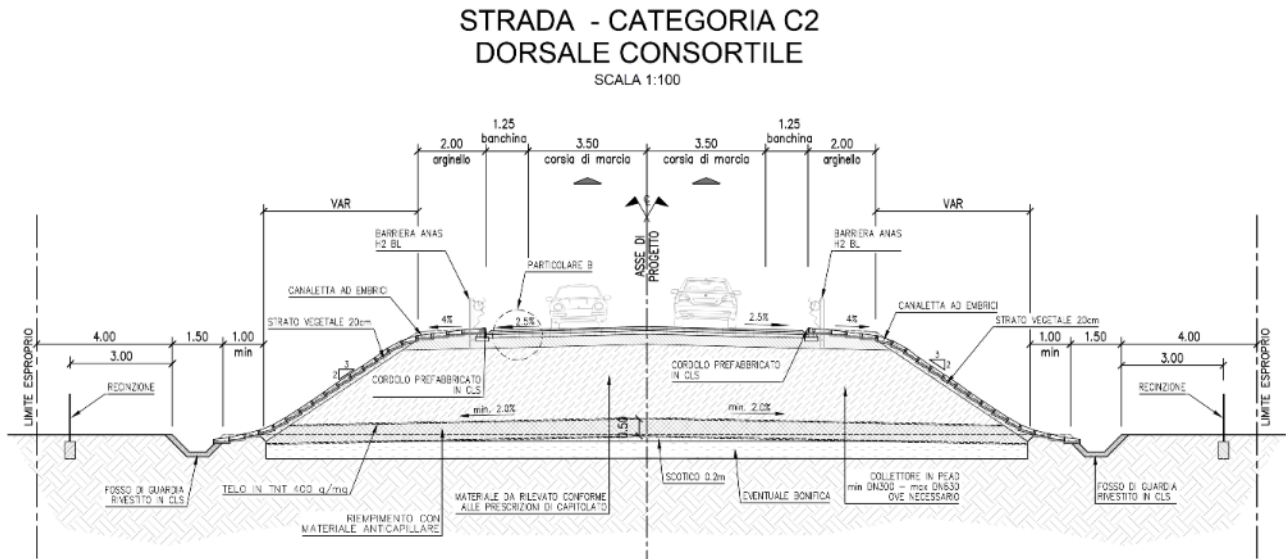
Sezione tipo in rilevato dell’asse secondario - Complanare Casic “Dorsale Consortile”
